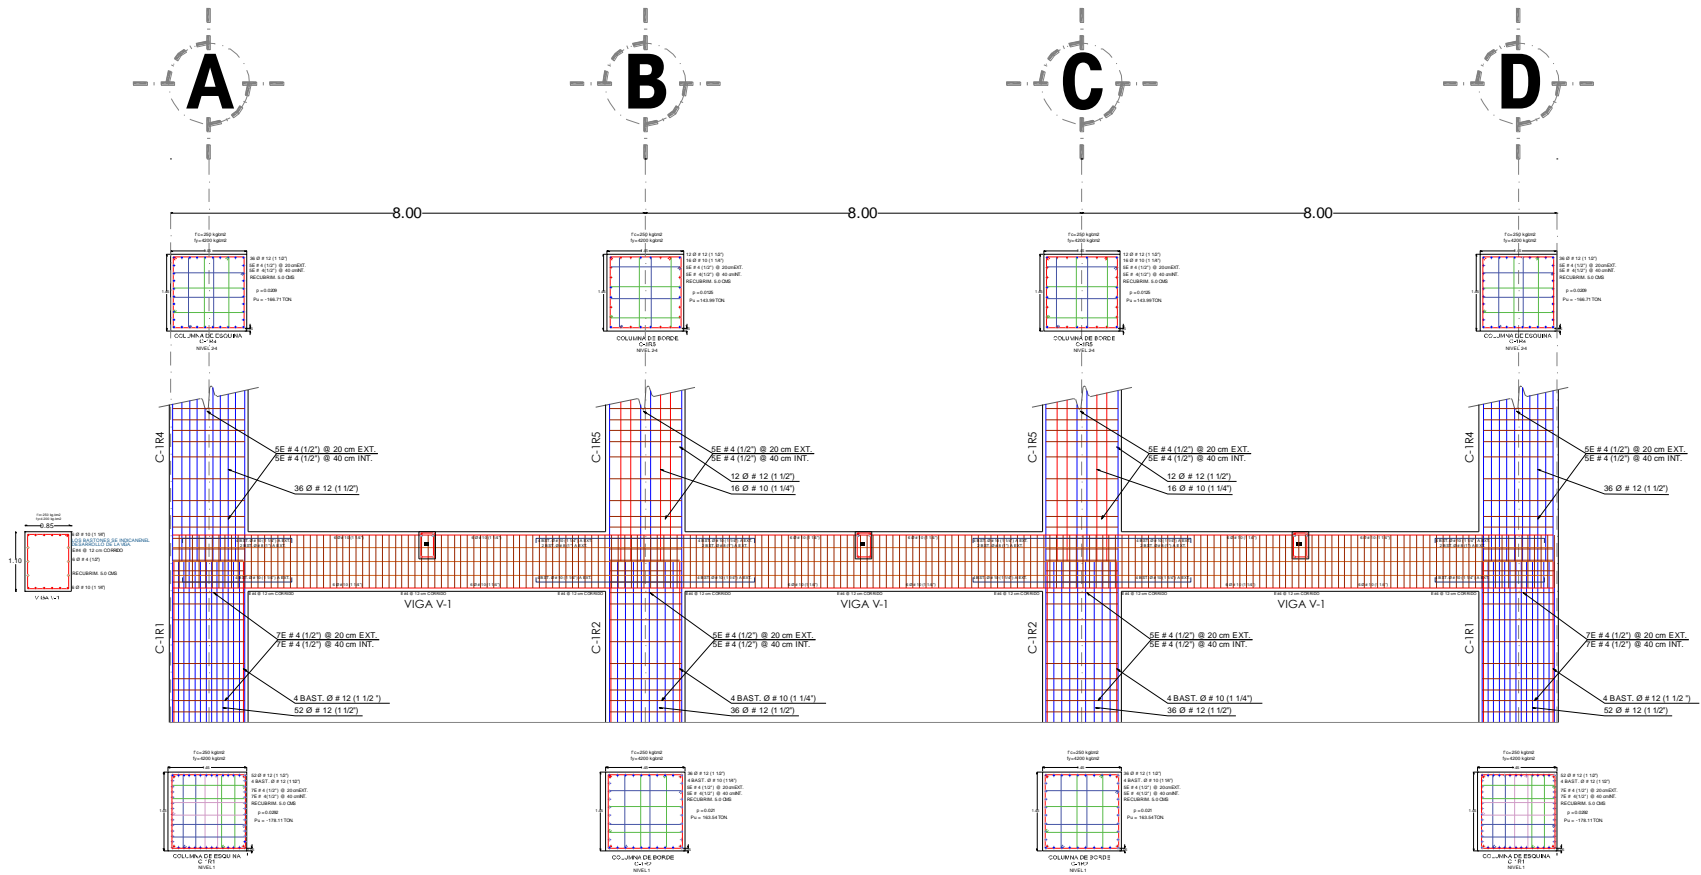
Alzado de armado de columnas y vigas de edificio de 12 niveles con base a la hipótesis de las NTCC-17.
